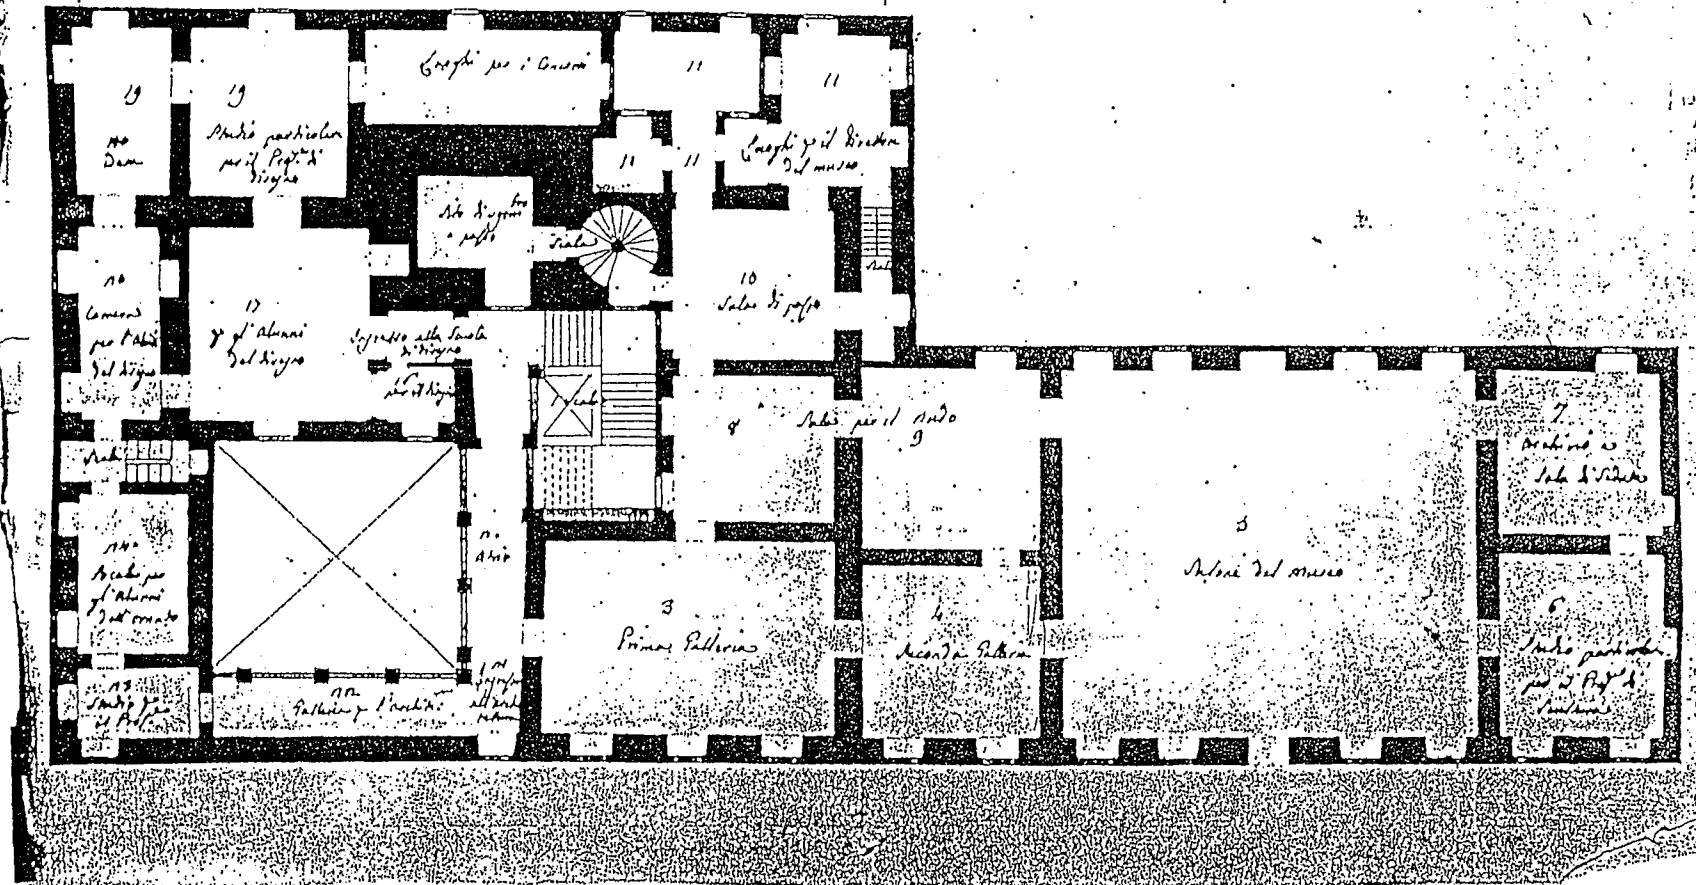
P. BARGIGLI, PIANTA PIANO TERRENO (1812).
